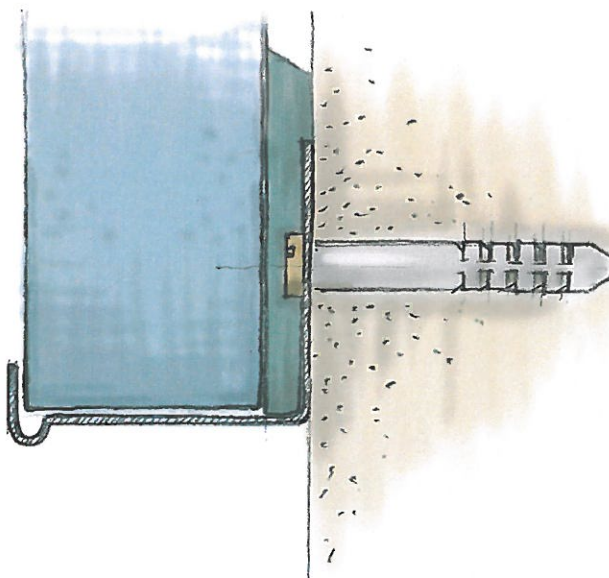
Sezione corretta del montaggio del profilo di partenza: leggero spessore di compensazione dietro il pannello
